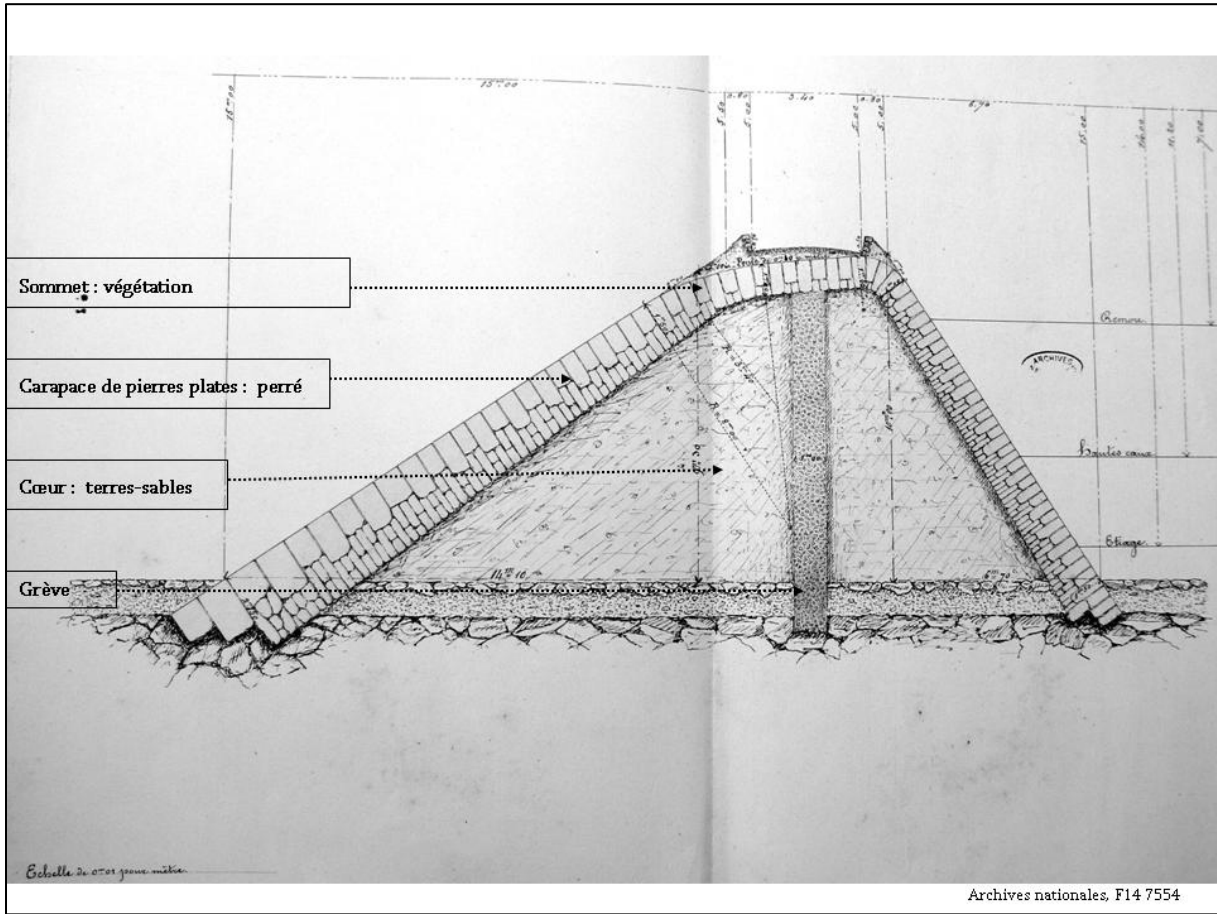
Plan en coupe d'une levée (XIX<sup>e</sup> siècle).
